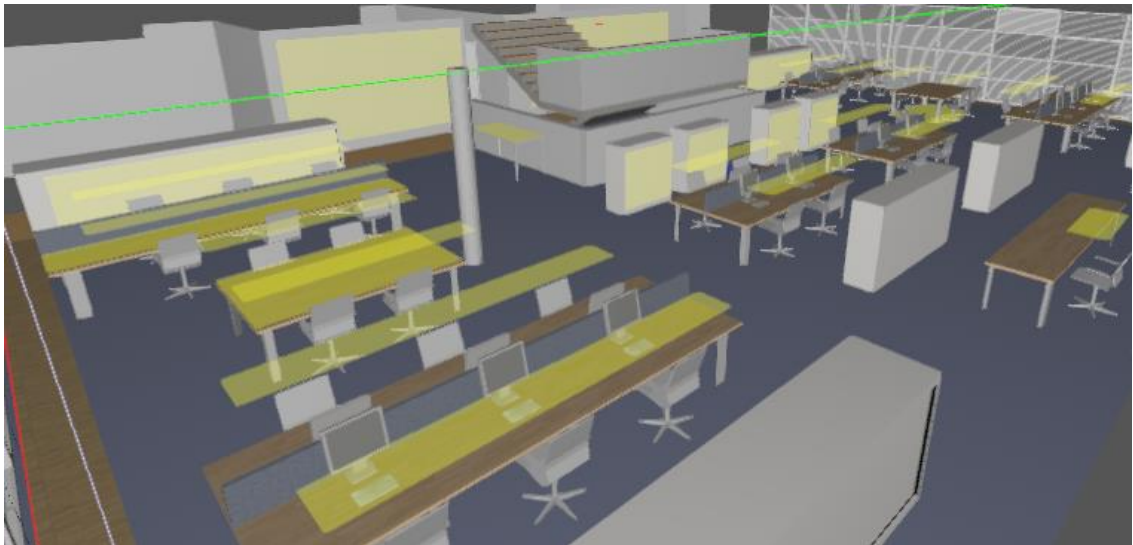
20 Posizionamento delle superfici di calcolo nel locale open-space
